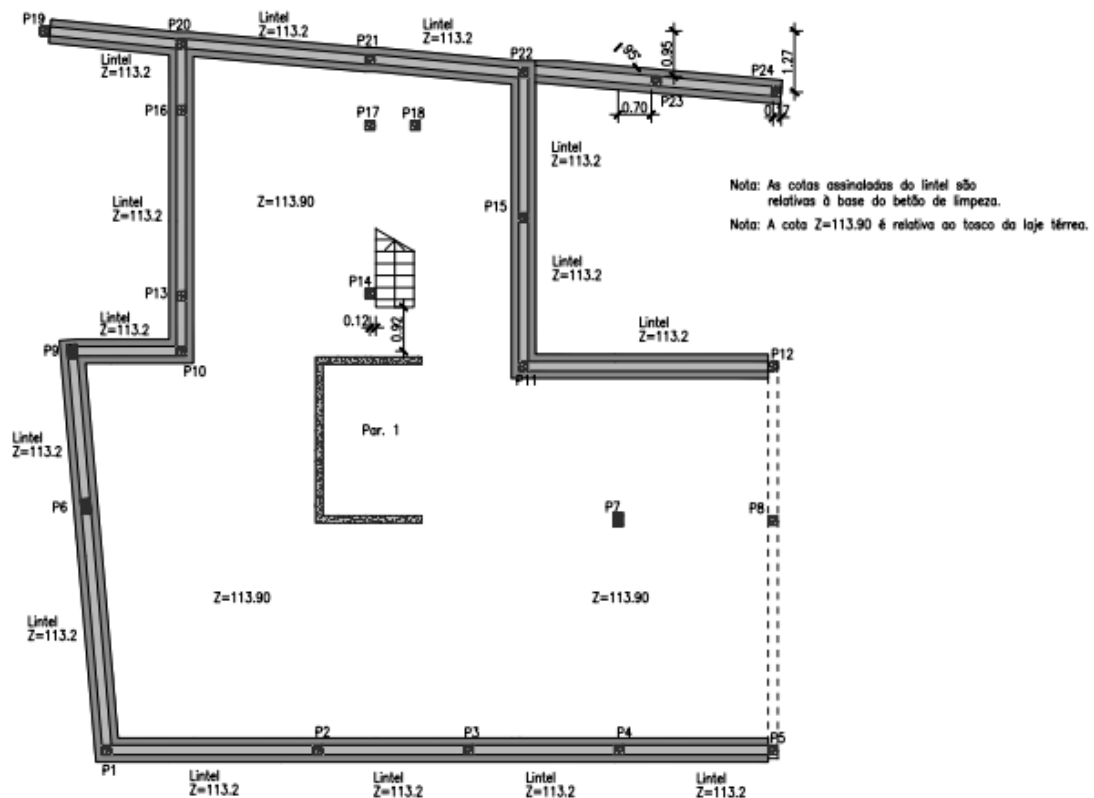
Planta estrutural das fundações [Fornecido pela empresa]
